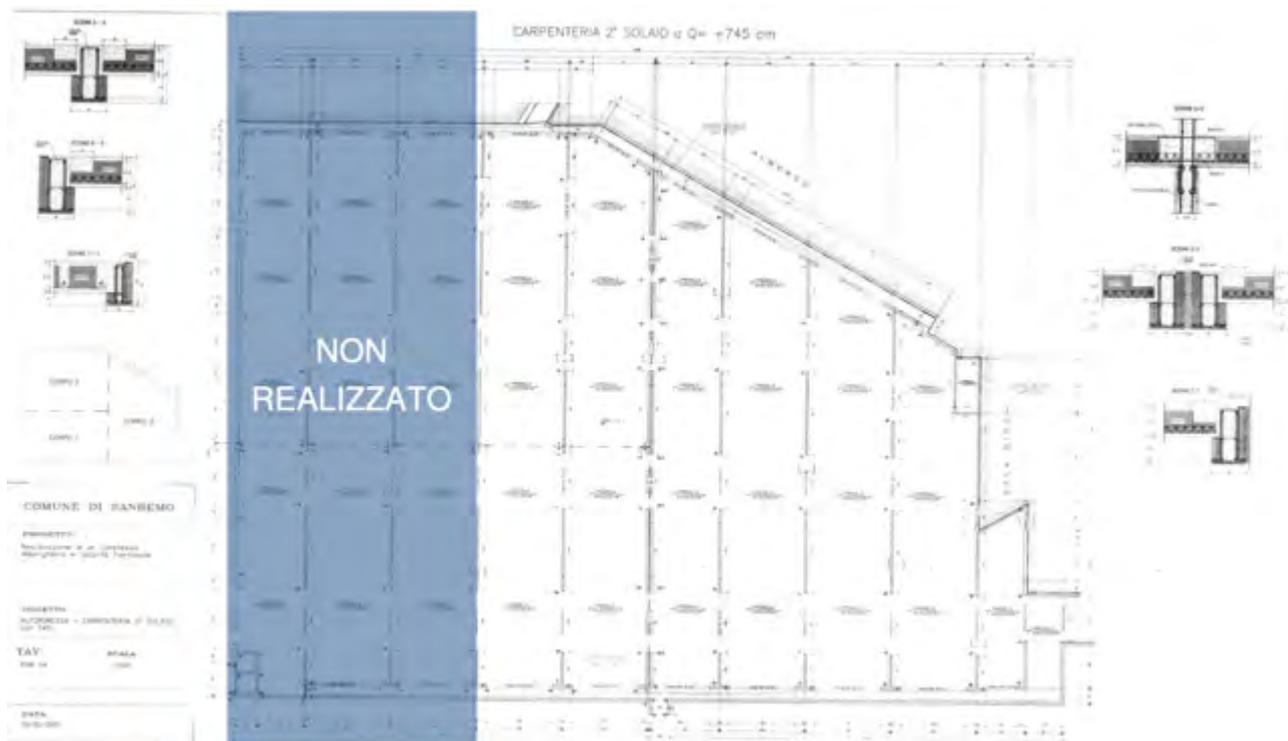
Carpenteria secondo solaio (Progetto originale delle strutture oggetto di demolizione).
